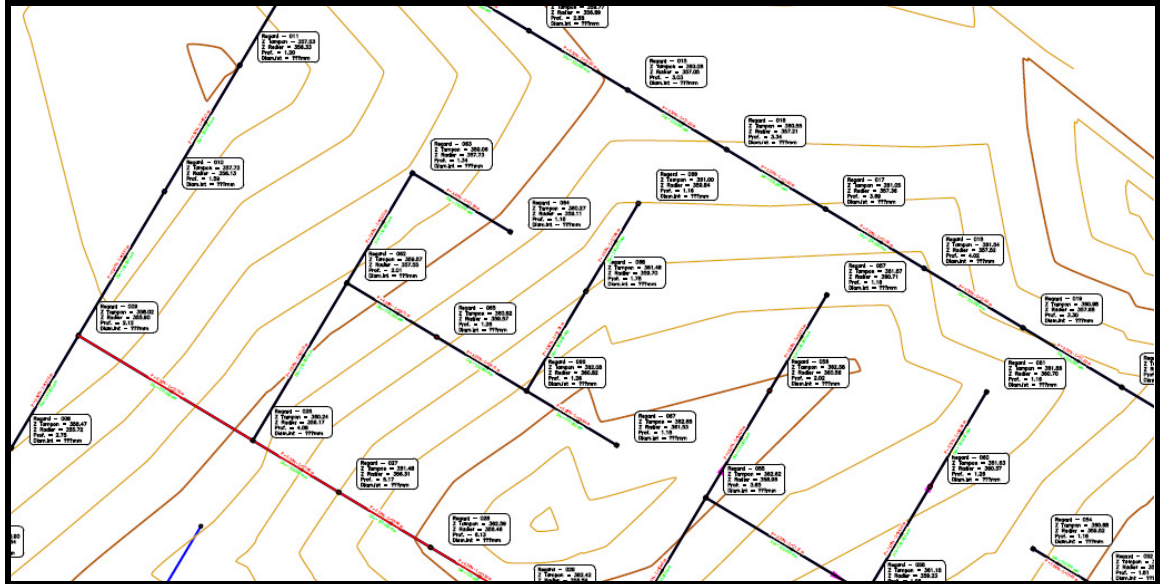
une vue agrandie sur une zone de tracé en plan d'assainissement
